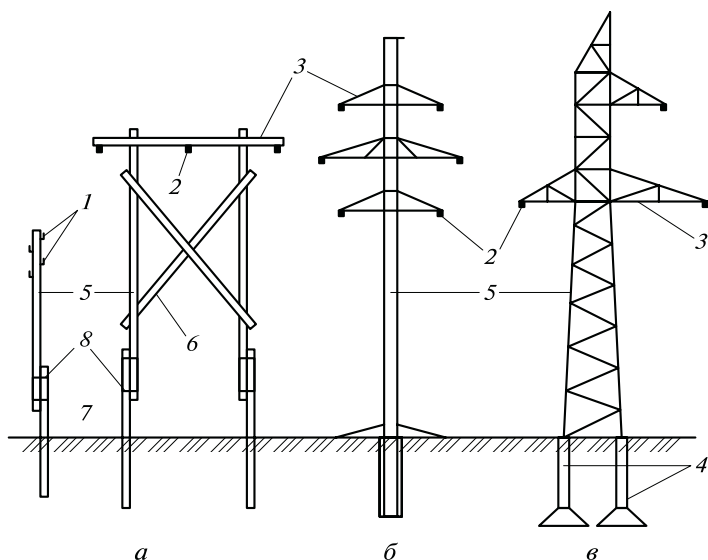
Деревянные (а), железобетонная (б) и стальная (в) опоры ВЛ:
